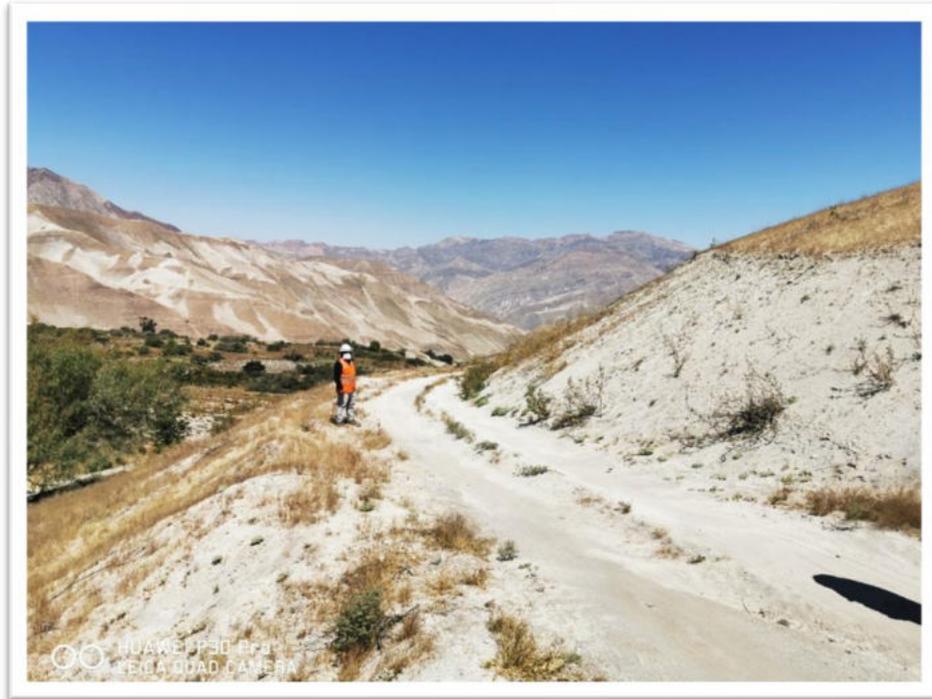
Vista de la inspección del terreno para verificar el ancho de vía del proyecto.
